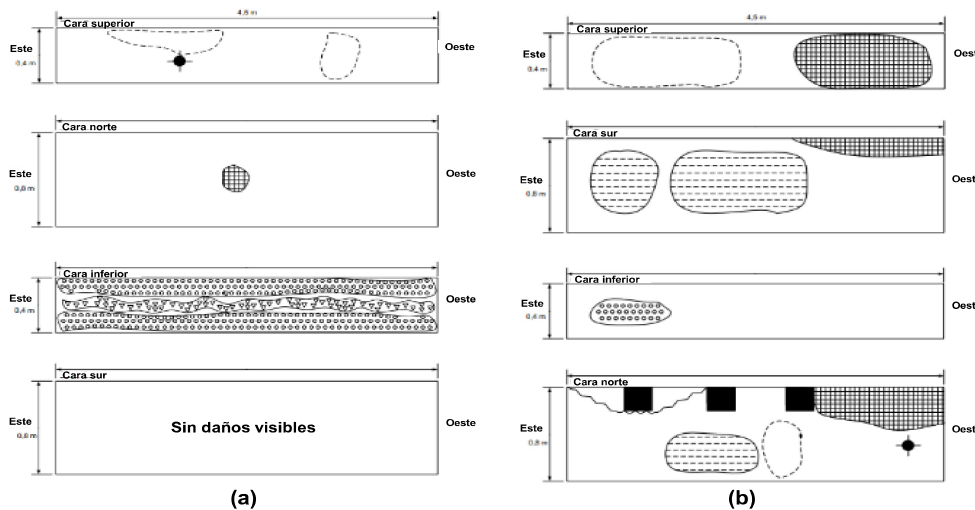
Levantamiento de daños de la viga transversal eje 21 lado oeste (LO) nivel 3 (a) y levantamiento de daños para la viga transversal eje 27 lado oeste en su nivel 3 (b).
